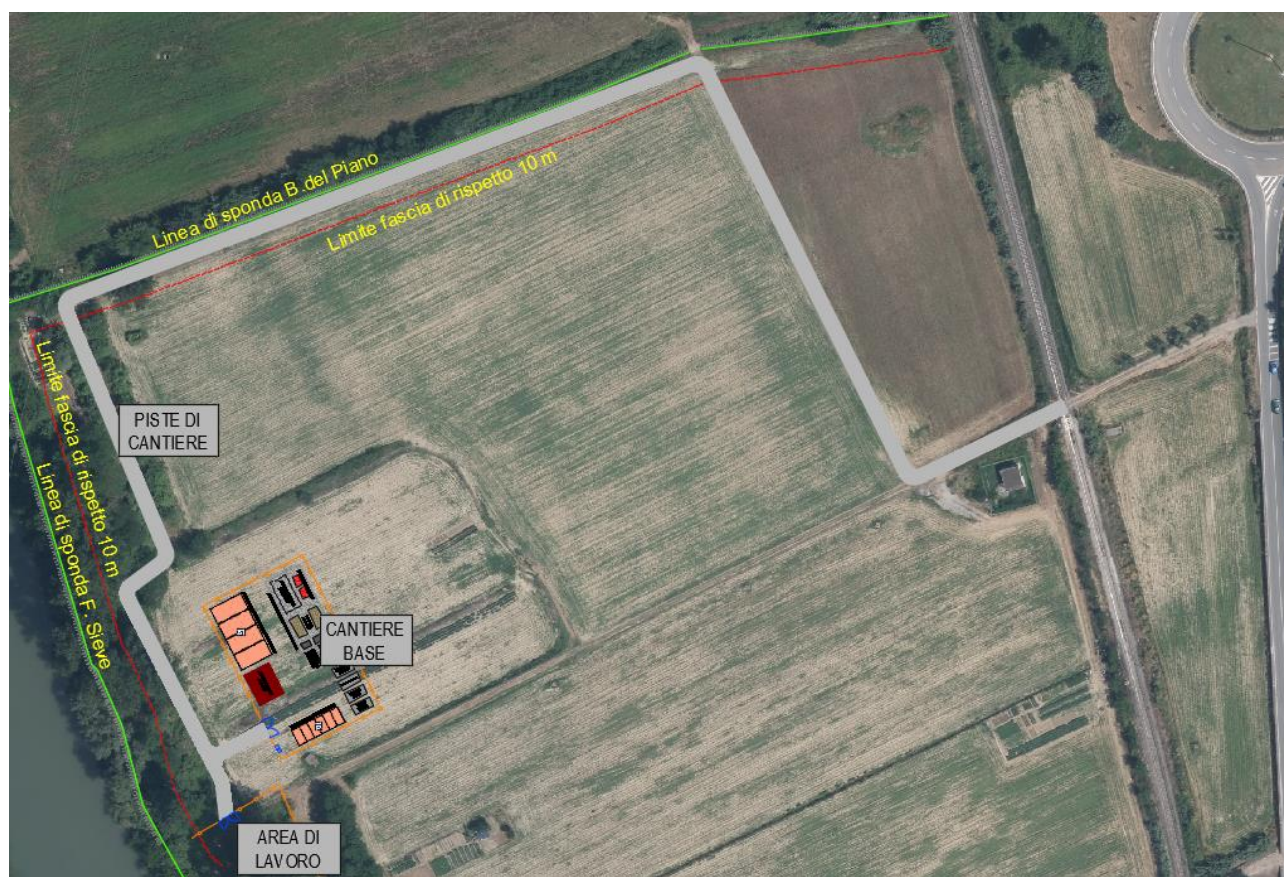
INDIVIDUAZIONE CANTIERE BASE E PISTE DI CANTIERE
